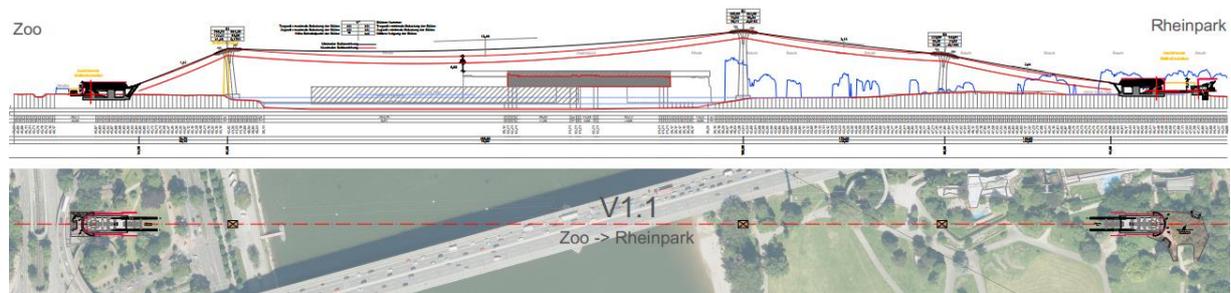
Längenschnitt, Lageplan Variante V1.1
